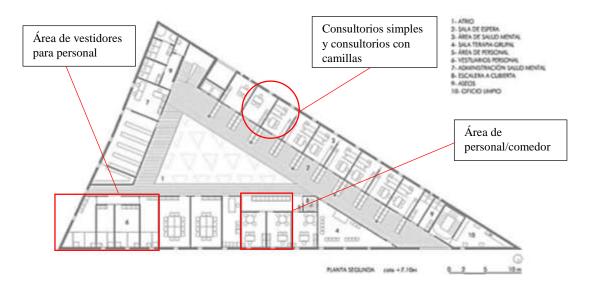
Planta segunda Adaptado de (Fernando Alda, 2010)
